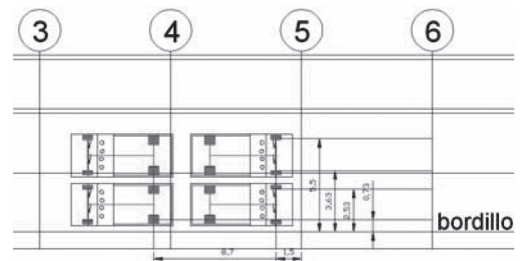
Localización en planta de las volquetas, en la segunda hipótesis, localización en el tablero del puente.
